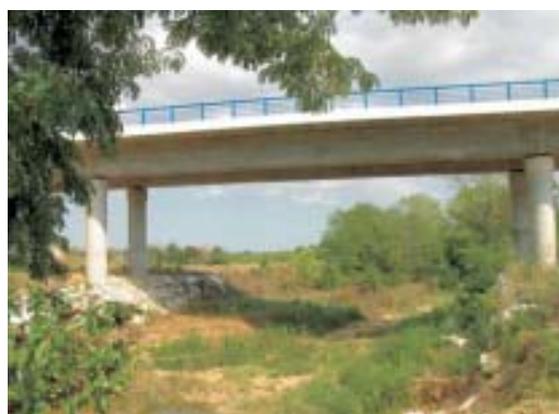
Pilas situadas fuera del cauce. Foto: R. Campeny.
